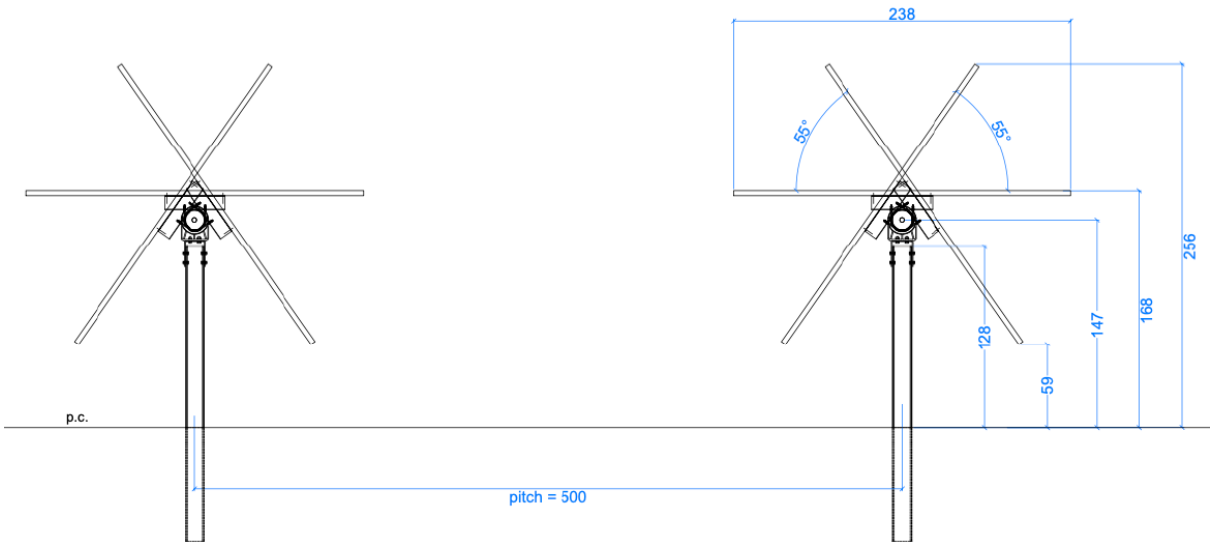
Dettaglio delle strutture di supporto (tracker) dei moduli fotovoltaici. Vista con rotazione +/-55°, pitch = 5 m.
